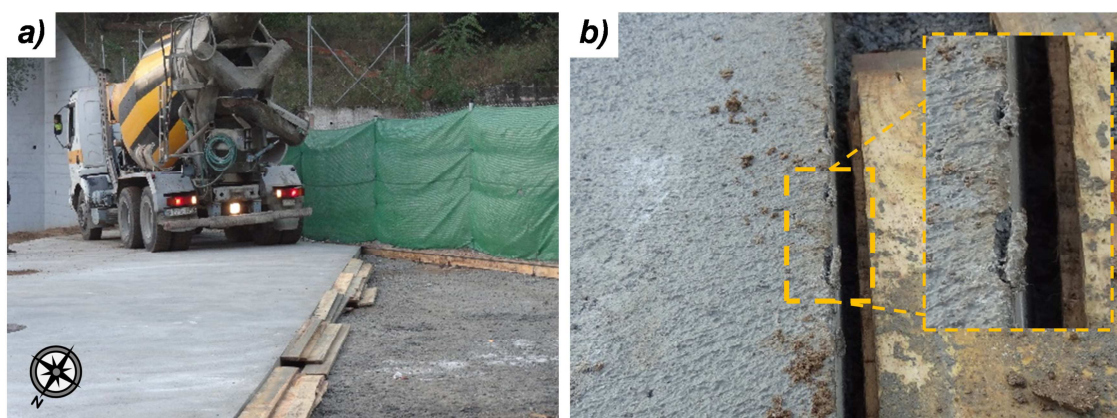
69 – Paso de camión por la losa con hormigón tipo HM-30/20/B a los 7 días del hormigonado de esta
